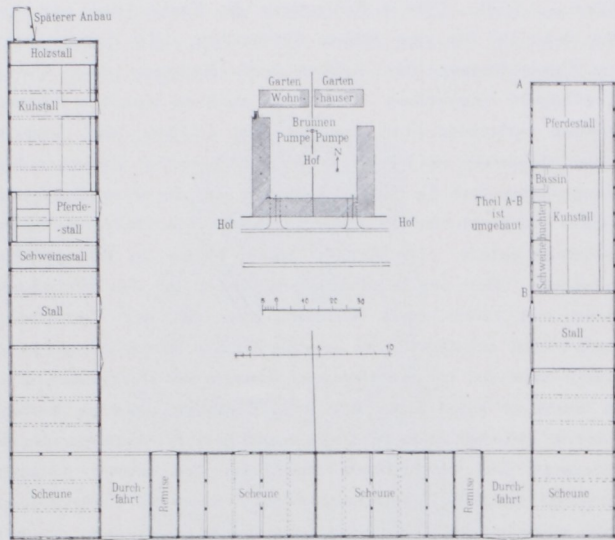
Zwillingshof in Stevelt. 1724. Lageplan und Wirtschaftsgebäude.
